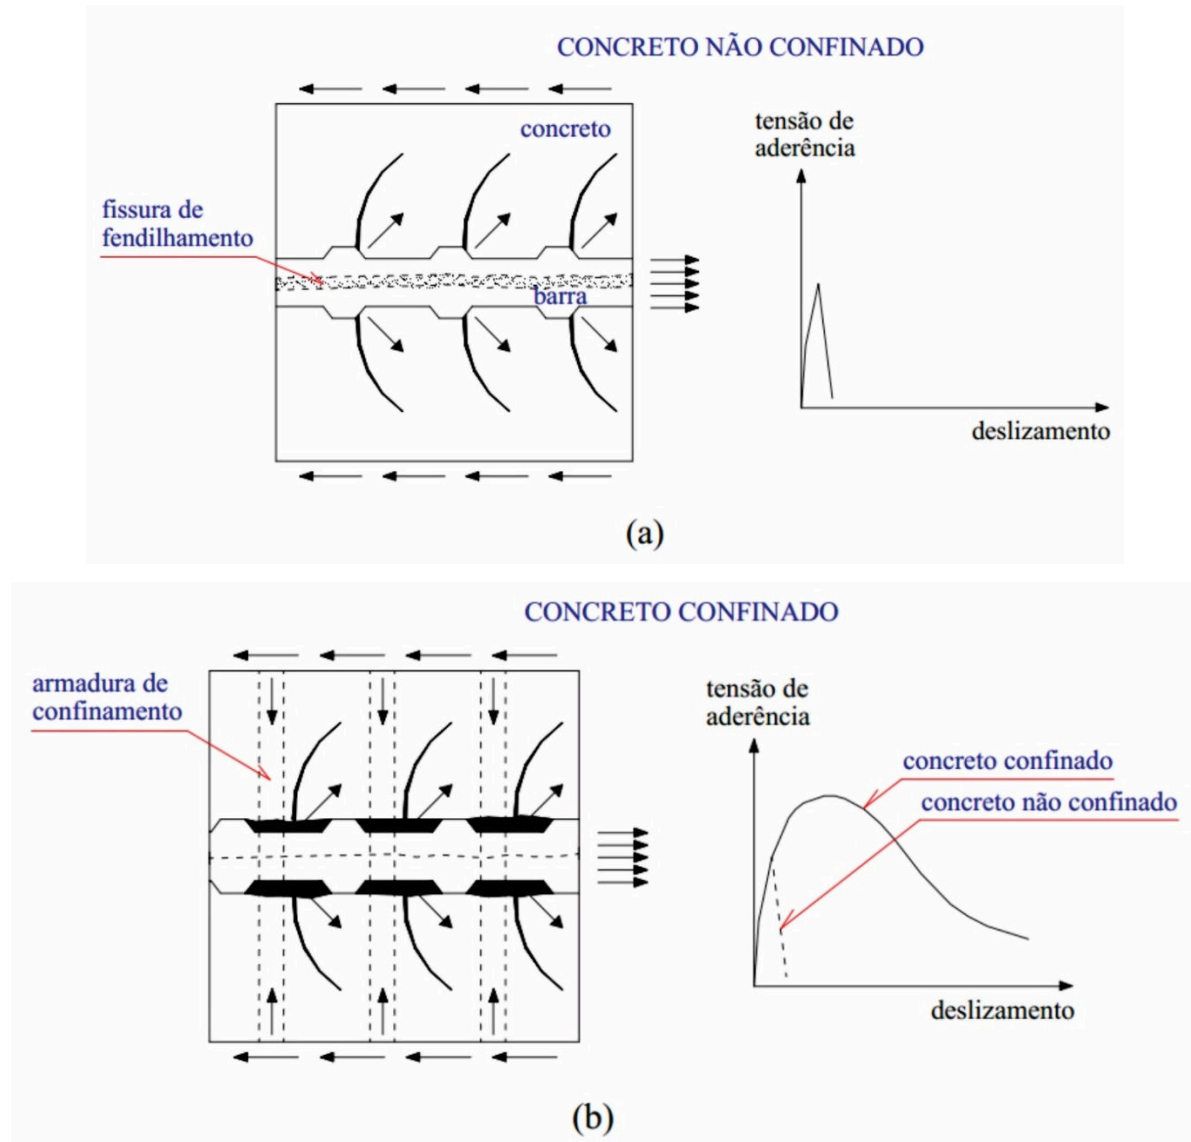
Ruptura por aderência por: (a) fissuração por fendilhamento em concreto não-confinado; (b) arrancamento em concreto confinado (FERNANDES, 2000).
